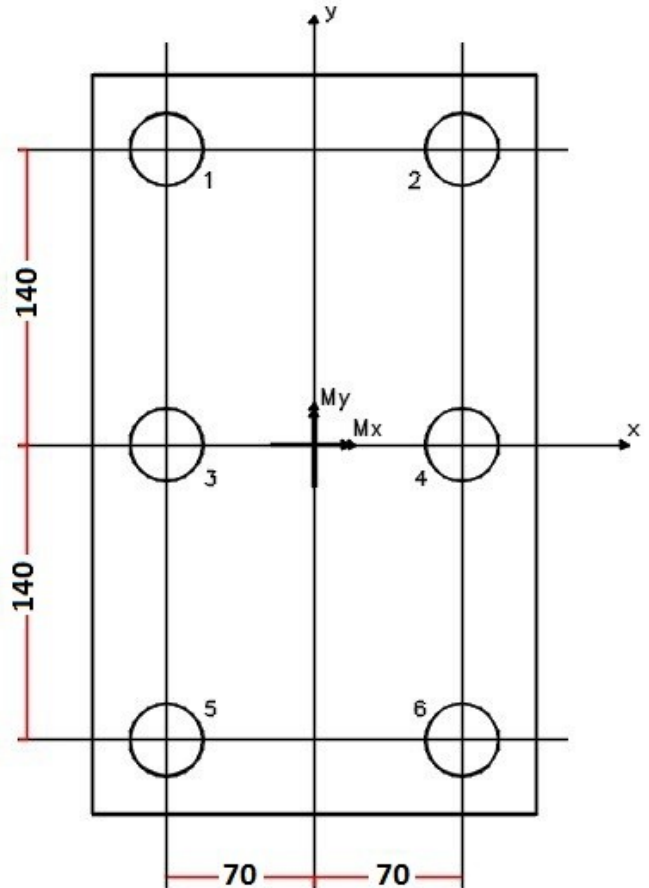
Planta baixa de bloco sobre estaca (medidas em cm)
